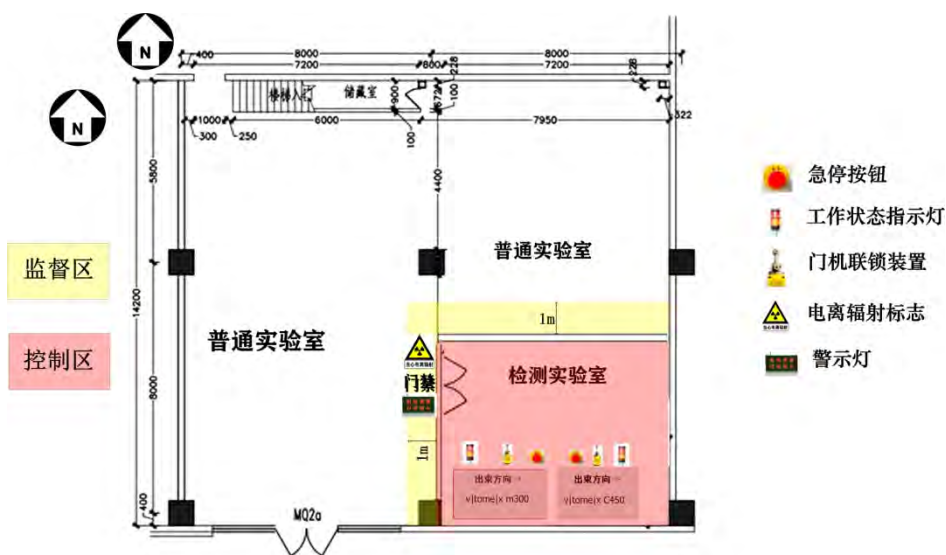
公司平面布局图和检测实验室辐射安全与防护设施布置示意图
